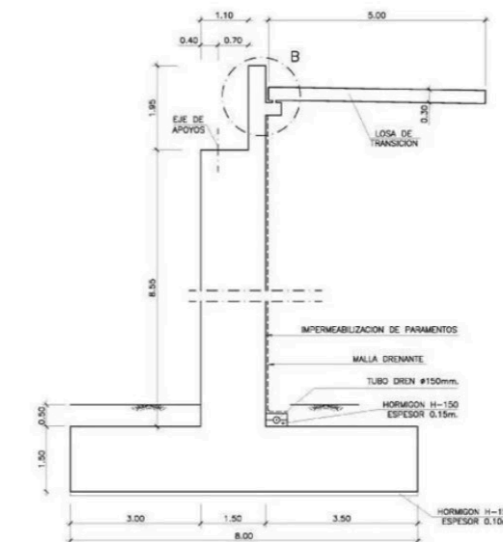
Sección transversal tipo de un estribo cerrado. Fuente: Blog structuralia.
